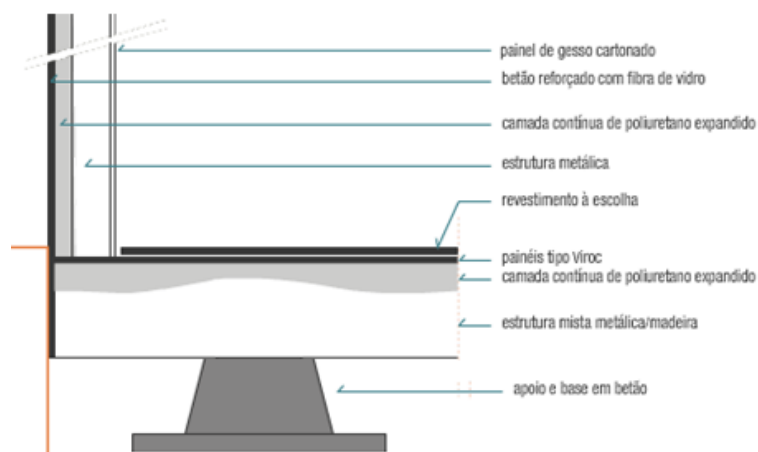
Pormenor construtivo da base e paredes exteriores (SIT, 2012)
